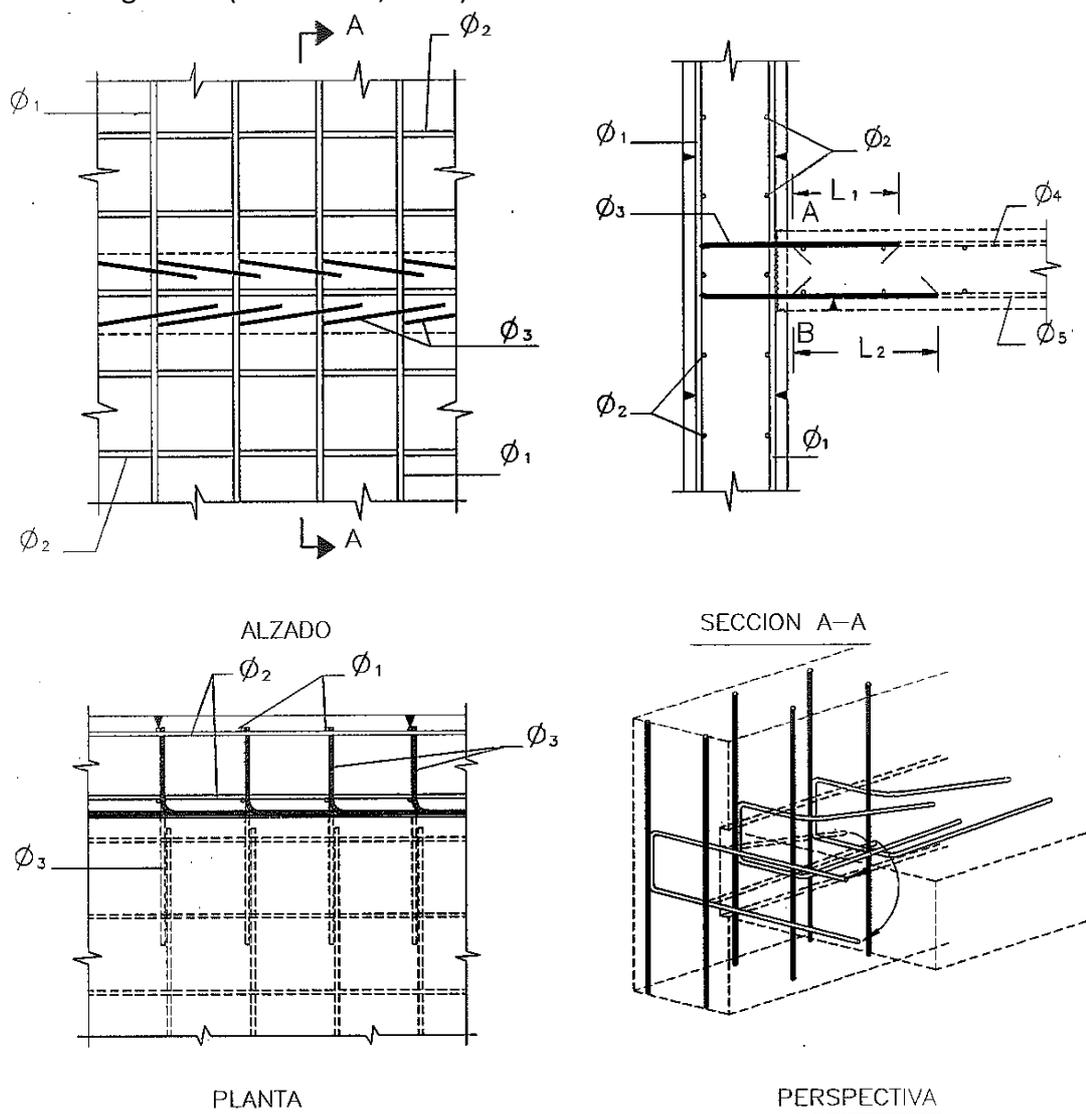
Detalle 3: Armadura de conexión doblada en muro pantalla (Detalles Constructivos J. Calavera, 1993)
